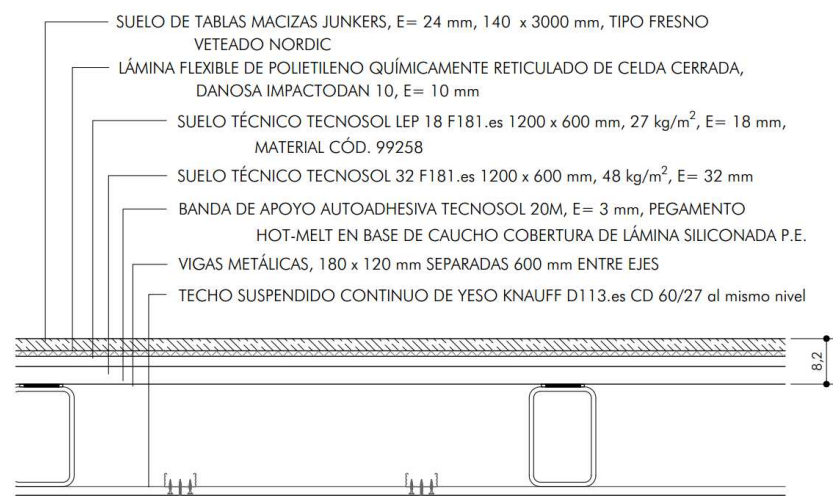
Sección constructiva de la entreplanta de la unidad de alojamiento
